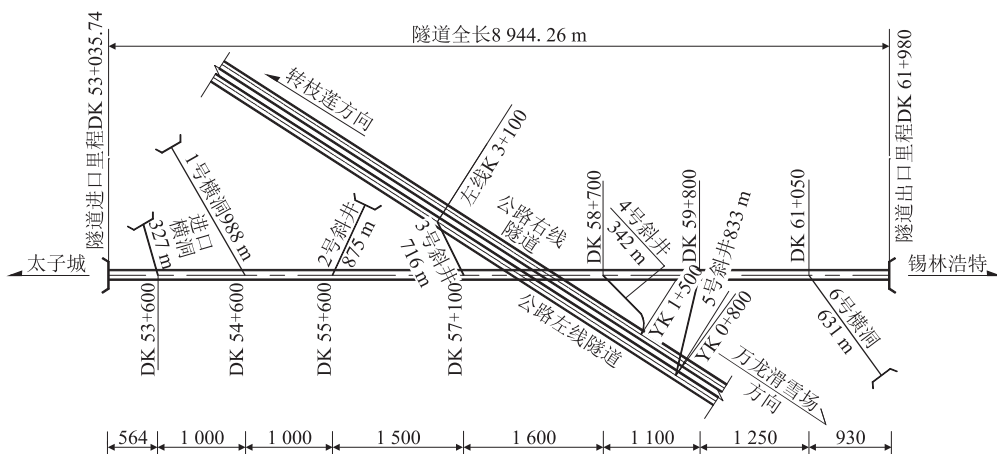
和平隧道辅助坑道布置及与既有线平面图(m)
